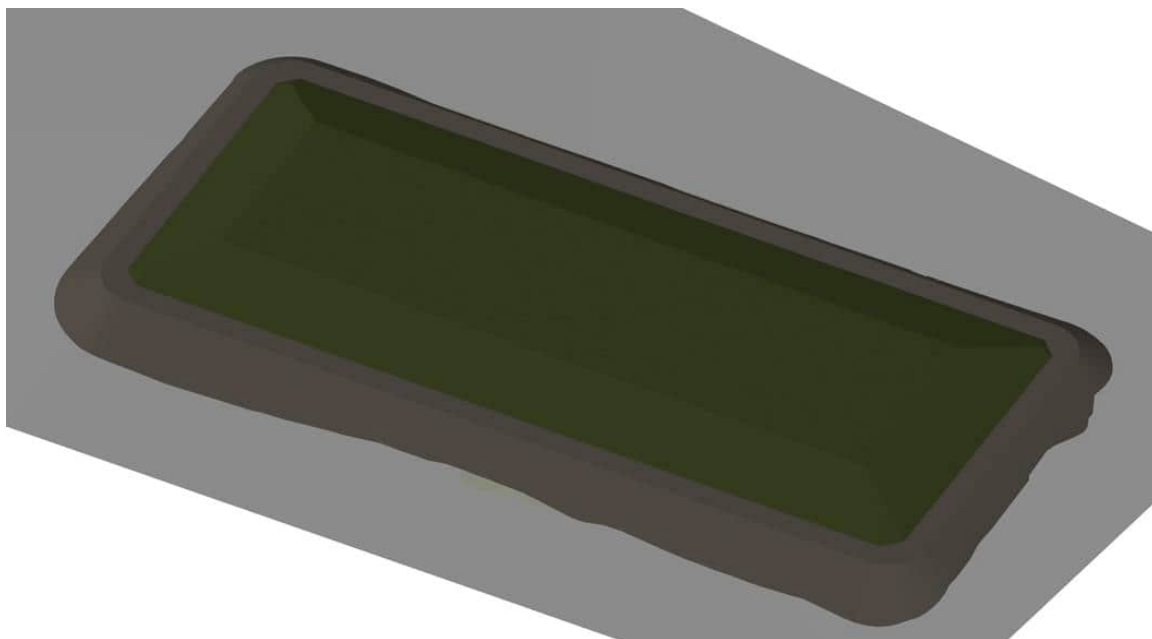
Окончательное заполнение площадки изоляции отходов
